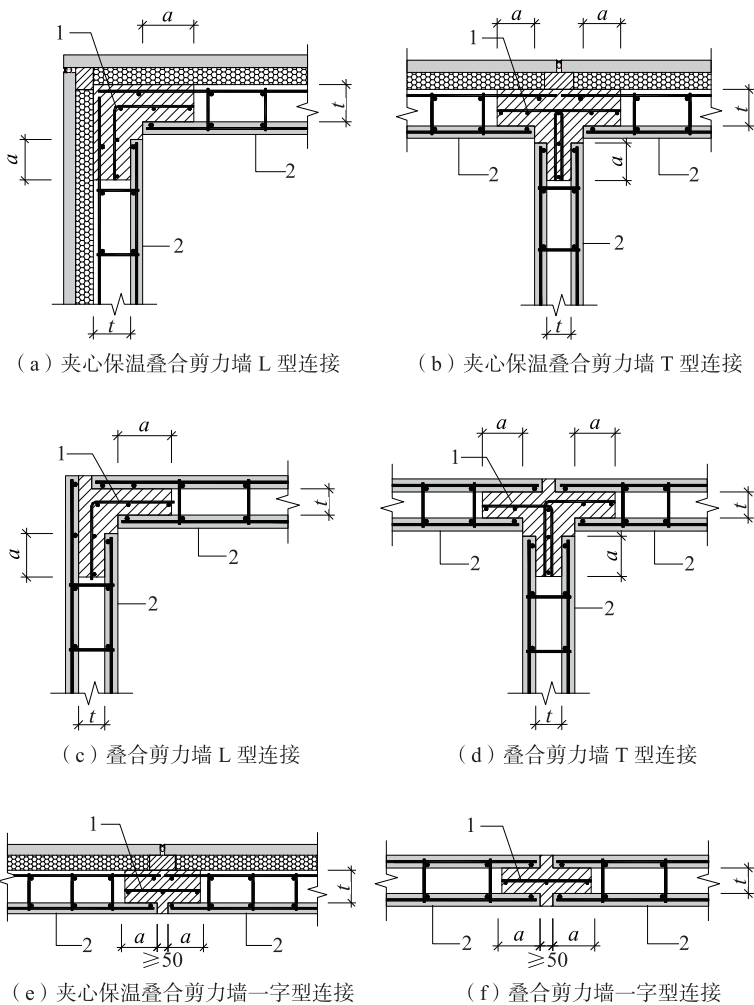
叠合剪力墙竖向接缝钢筋网片连接构造
